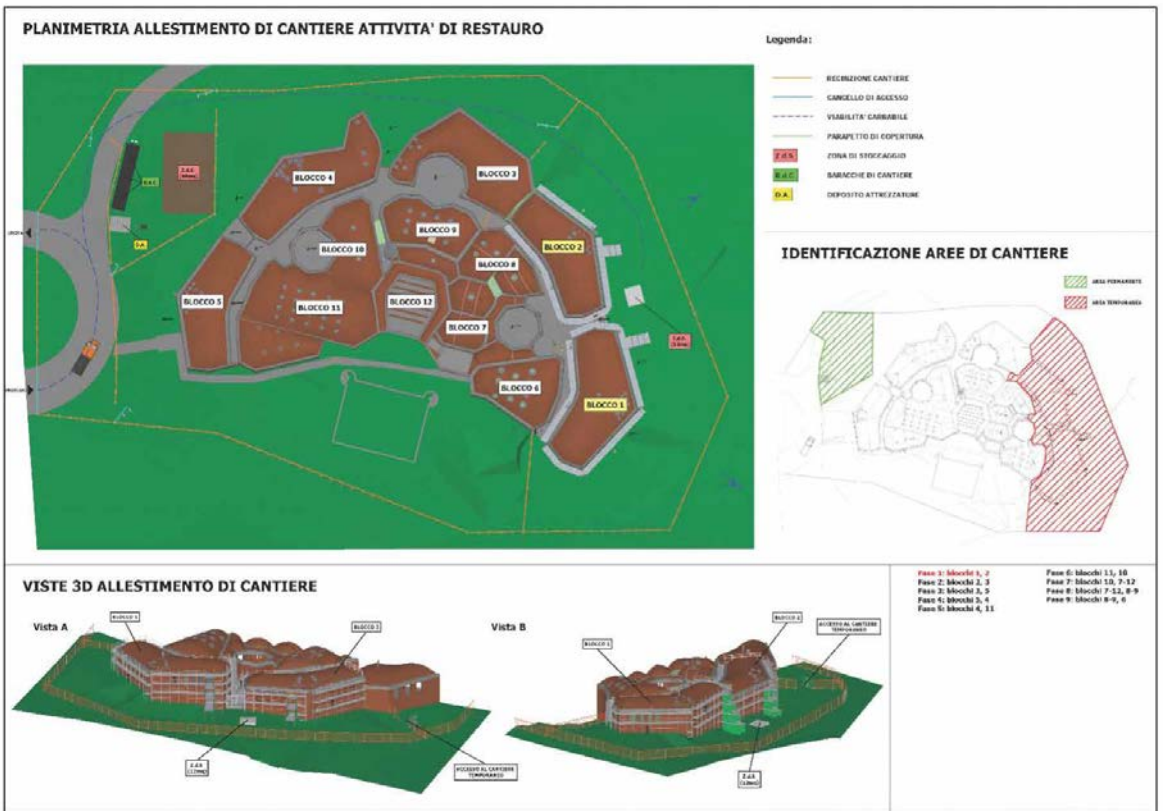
| Progetto de la obra. | Progetto del cantiere.
